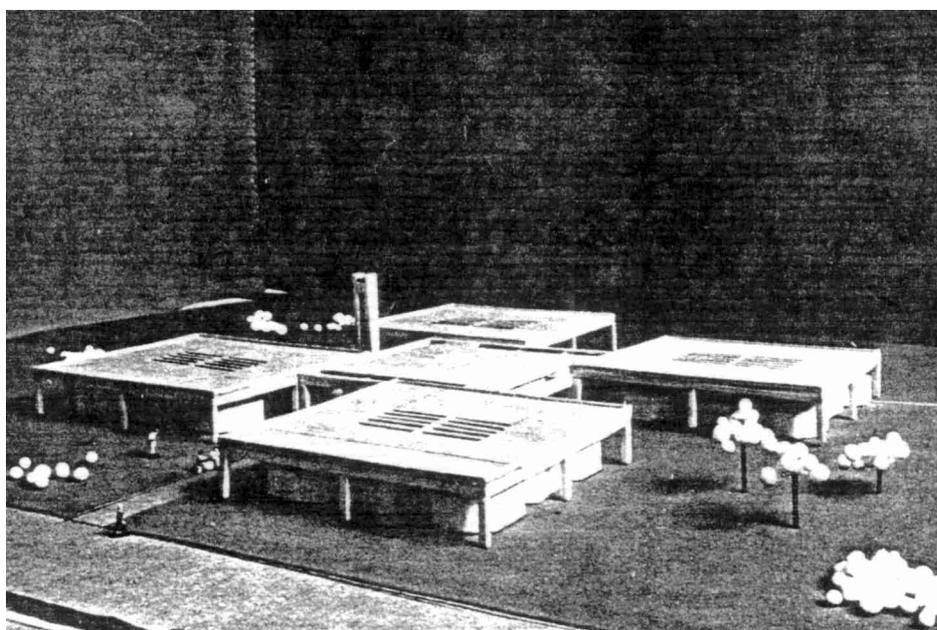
Projeto de sistema construtivo em elementos industrializados de concreto armado, autoportantes, com crescimento horizontal - menção Honrosa (arquitetos Marco Aurélio Ferreira e William Ramos Abdala).
